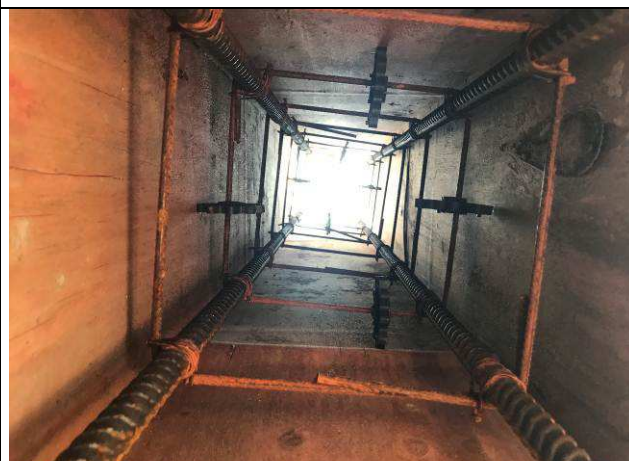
C: Formas e armaduras do pilar P08 do prédio do arquivo.
